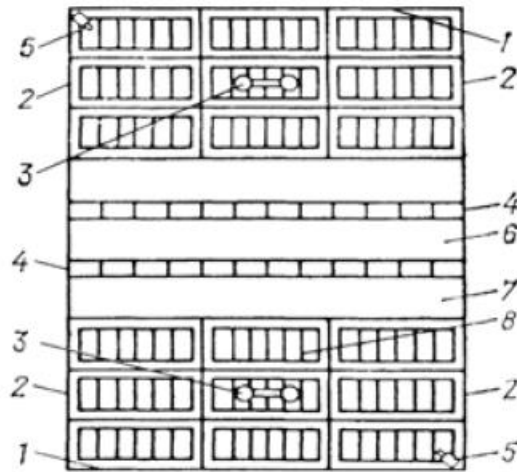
Схема групового станка: 1 – дверці; 2 – огорожа; 3 – установка для опромінення; 4 – самогодівниця; 5 – напувалка; 6 – бункер самогодівниці; 7 – настил; 8 – підлога
